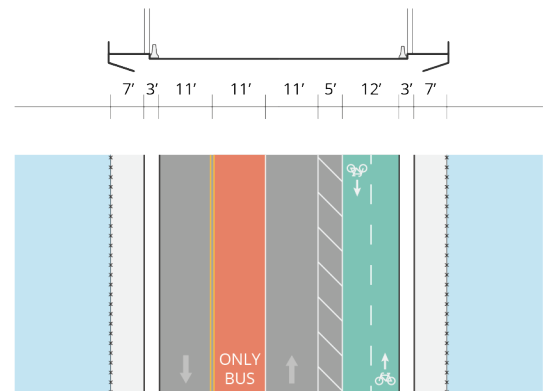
PUENTE DE LA CHELSEA STREET - CONDICIÓN PROPUESTA
